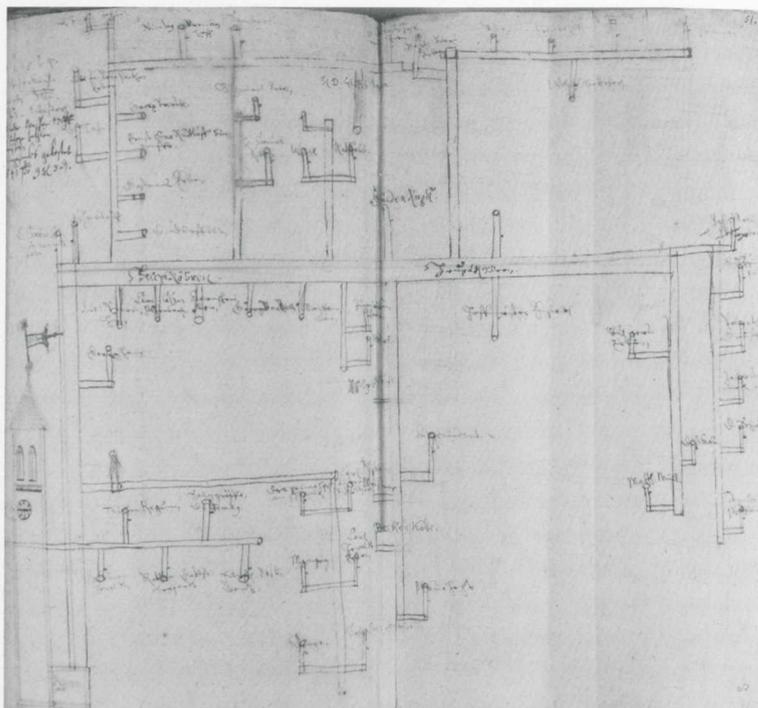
Mattes Moß: Röhrenplan der Stadt Halle a. d. Saale, um 1552 (?), Halle, Stadtarchiv
